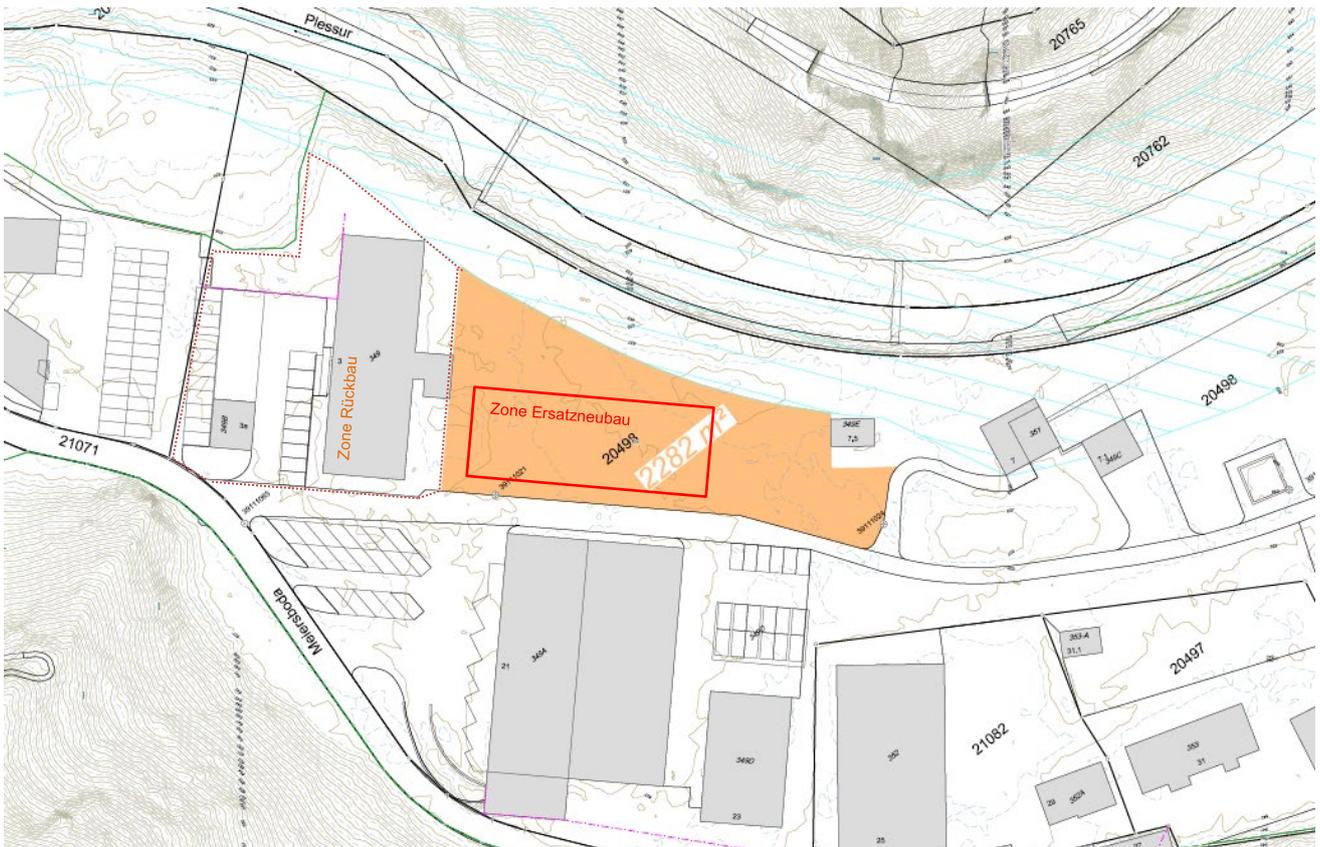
Perimeter Wettbewerb 2282 m2, möglicher Fussabdruck und Ausrichtung Ersatzneubau und Zone Rückbau
